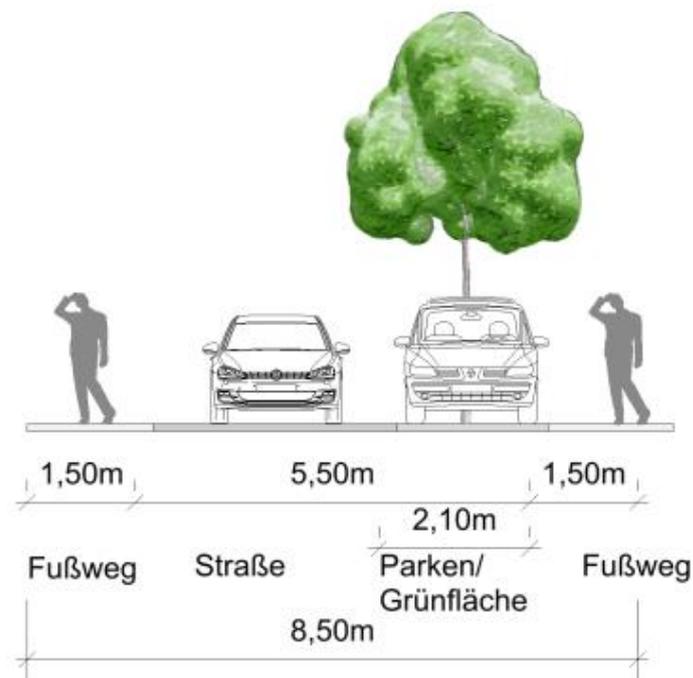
Möglicher Straßenquerschnitt Planstraße B-E und G und H (mit und ohne Parken)
